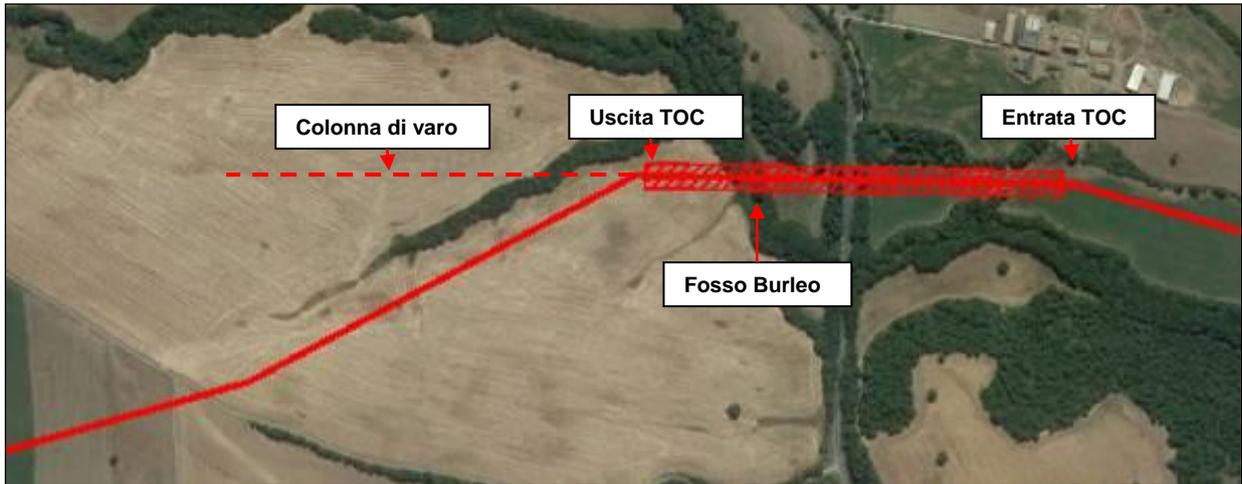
/A – Schema planimetrico della TOC per l’attraversamento del F.so Burleo
